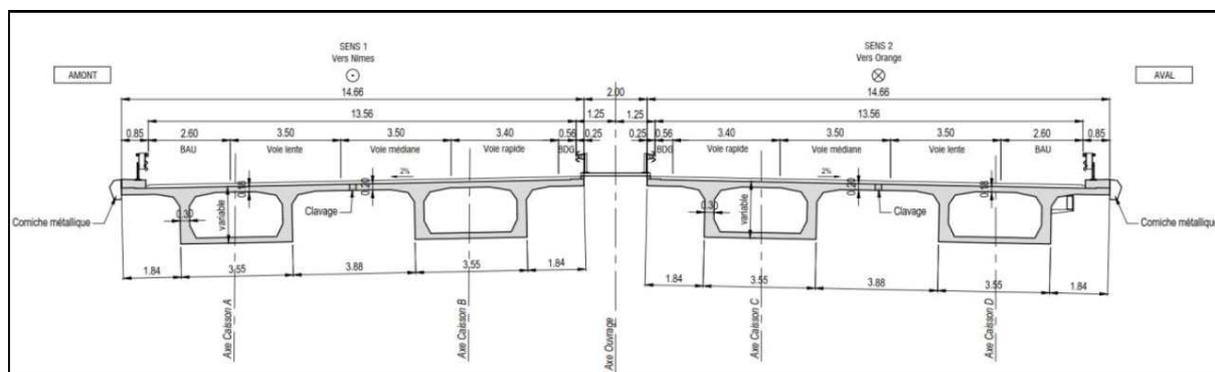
Coupe transversale fonctionnelle de l'ouvrage (Arcadis, 2022)
